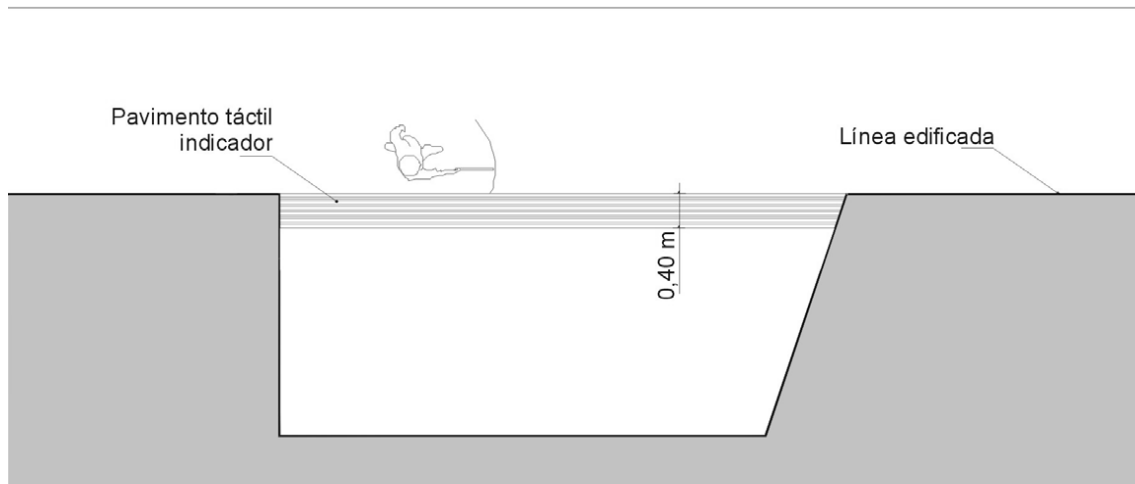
Franja de pavimento táctil indicador direccional que da continuidad a la línea edificada
